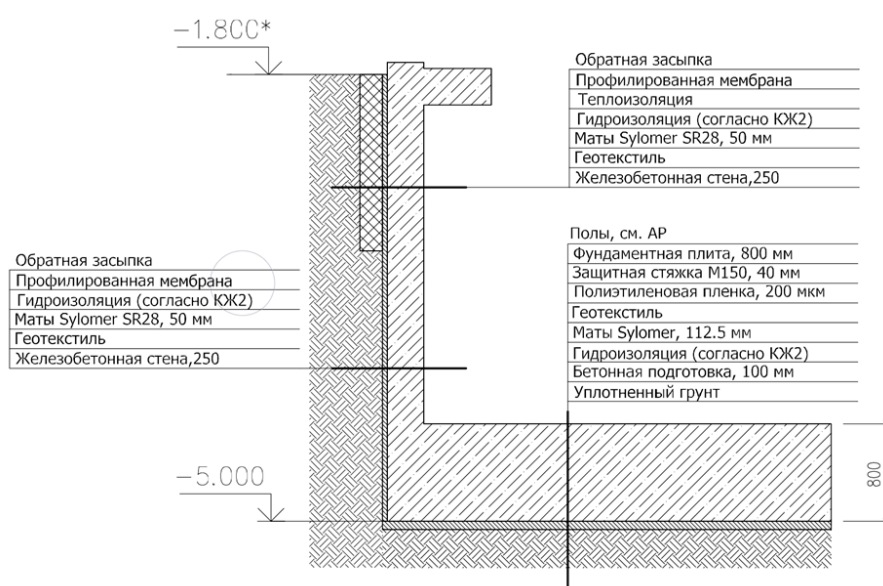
Схема укладки виброизолирующих матов под фундаментной плитой
